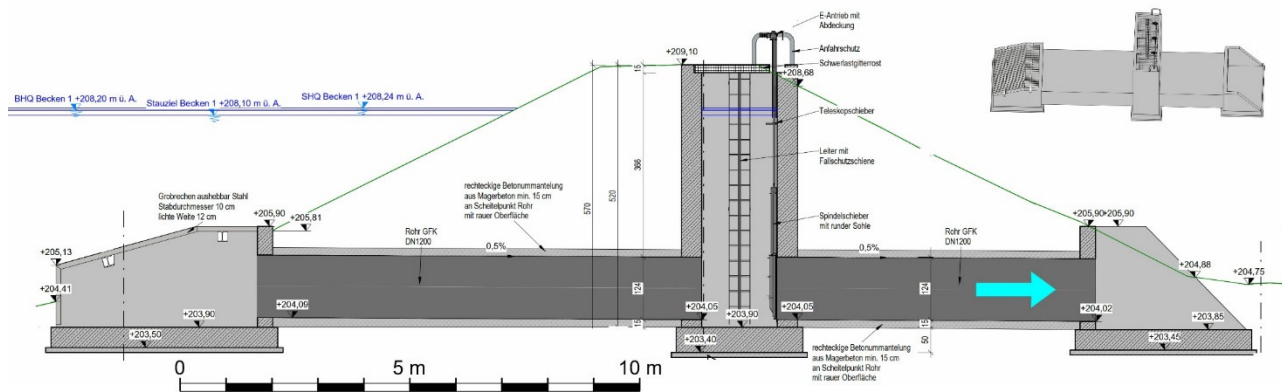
Längsschnitt durch das Auslaufbauwerk (Quelle: Einlage 028)
